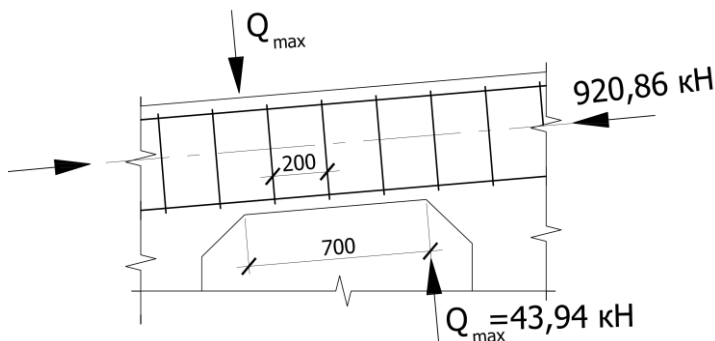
К расчету верхнего пояса балки по наклонным сечениям
